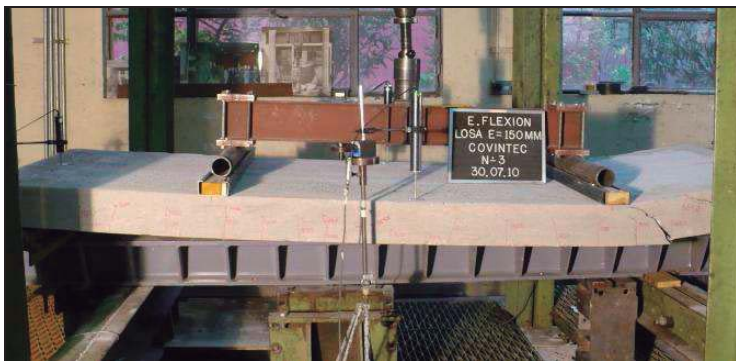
Vista general del montaje del ensayo de flexión al panel.
